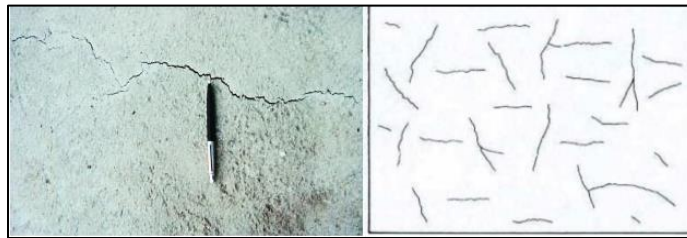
Fisuras por contracción plástica en la superficie del concreto hidráulico. Fuente: propia.
